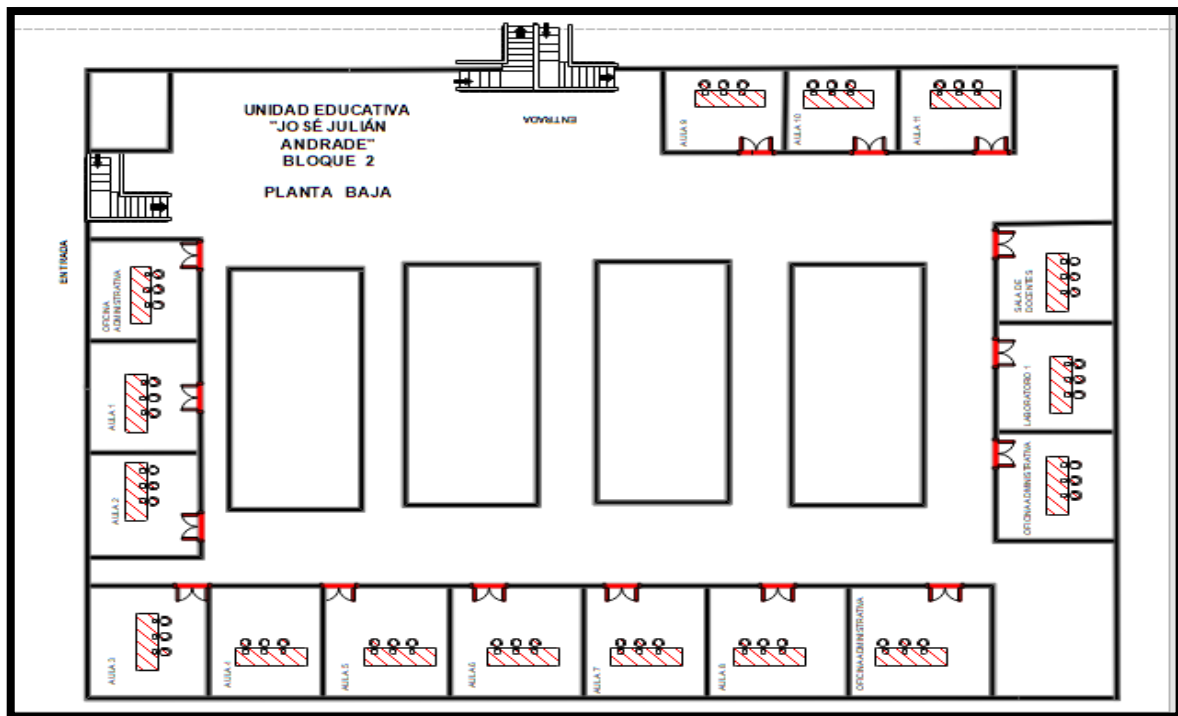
Plano de la estructura del bloque 2, planta baja de la institución
